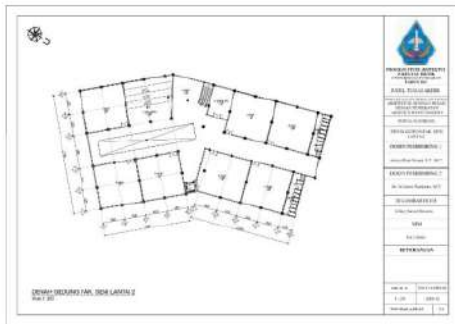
Denah Gedung Fak. Desain Lantai 1
